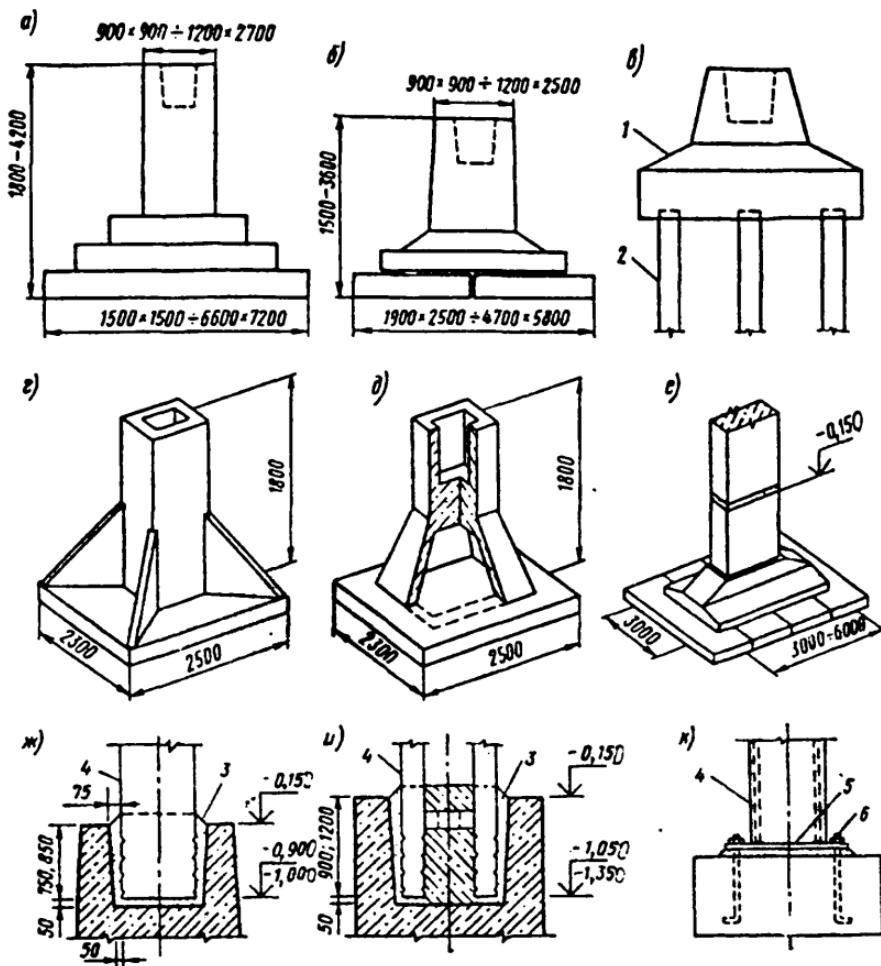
Железобетонные фундаменты и способы заделки в них колонн:
